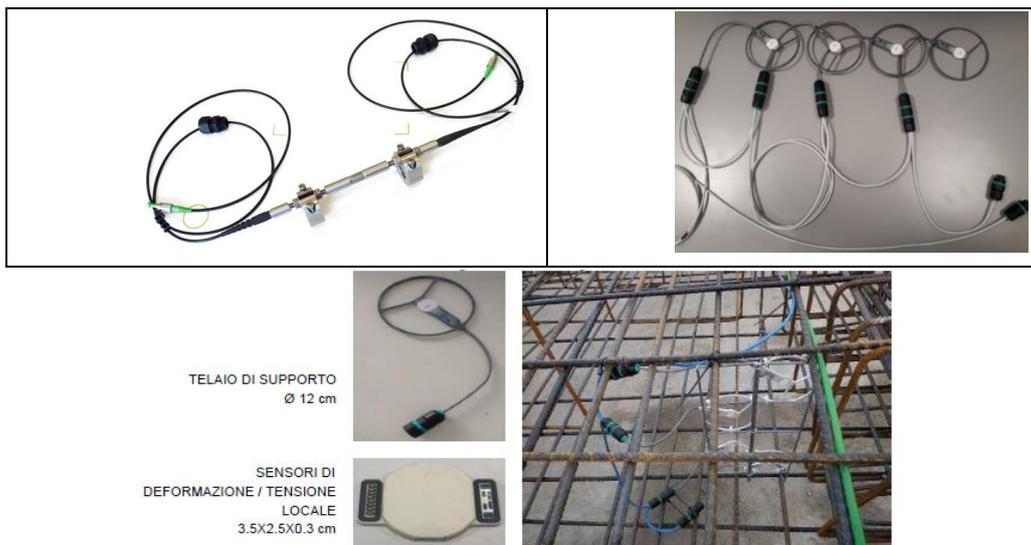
Sensori di deformazione/tensione locale e installazione all'interno delle strutture.
